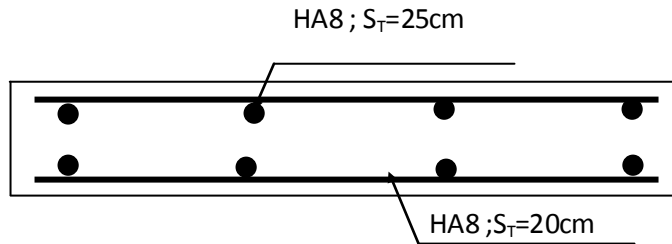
Coupe transversale en appui de dalle de 2 appuis
